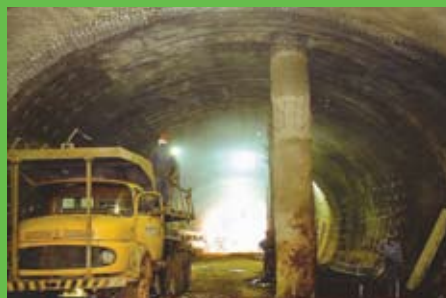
Passagem do túnel de via sob estrutura com fundação profunda, Metrô de Brasília (CBT - 2006)
